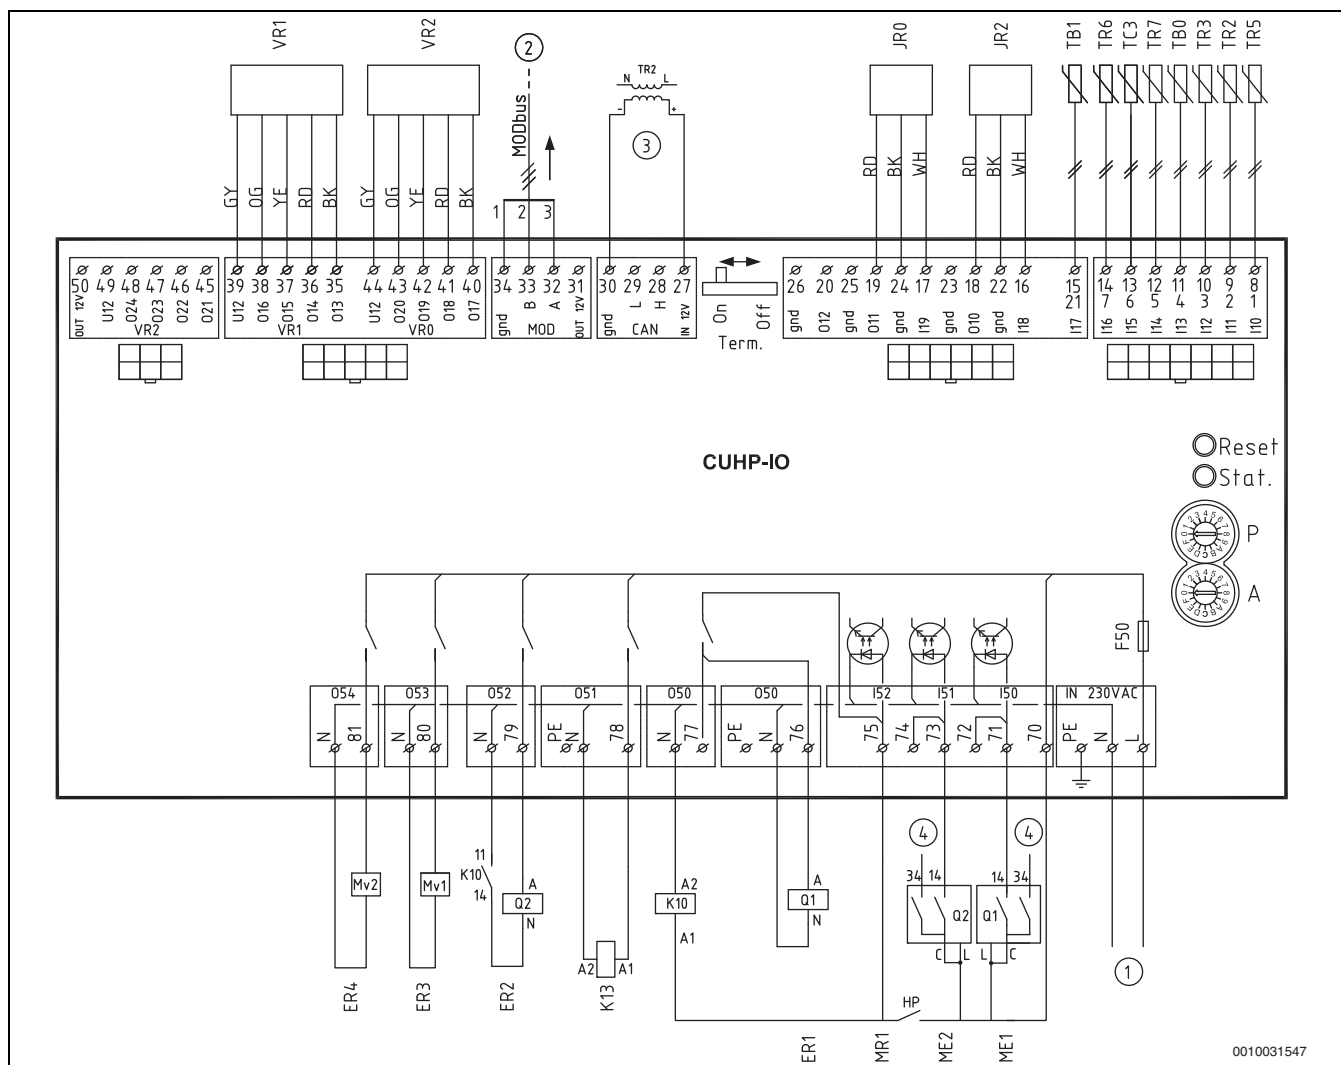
HP-karta, stykače kompresorů, stroj 38-48 kW
